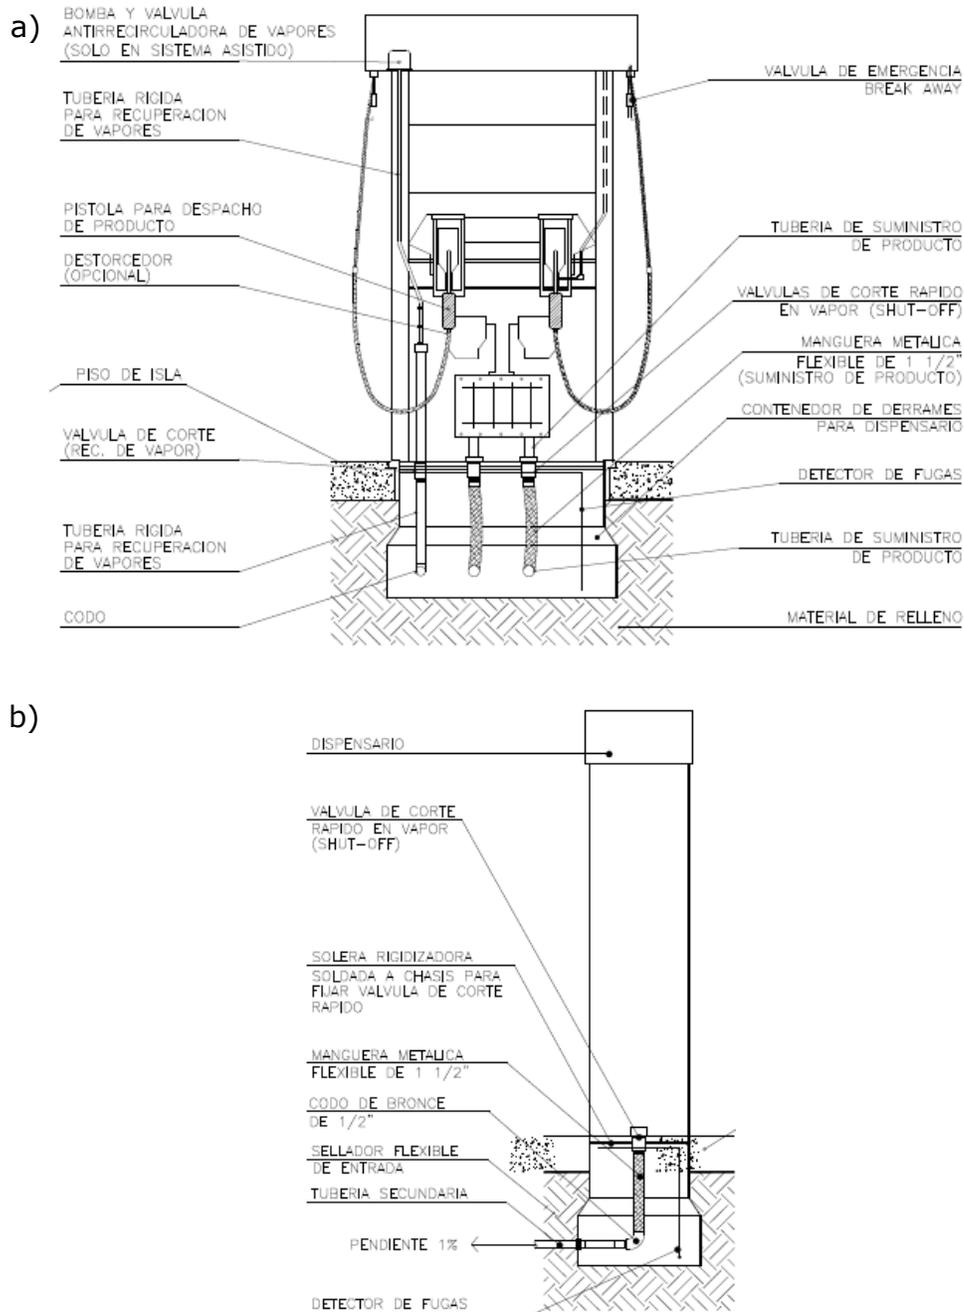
Detalle del dispensario. a) Corte longitudinal y b) Corte transversal.
